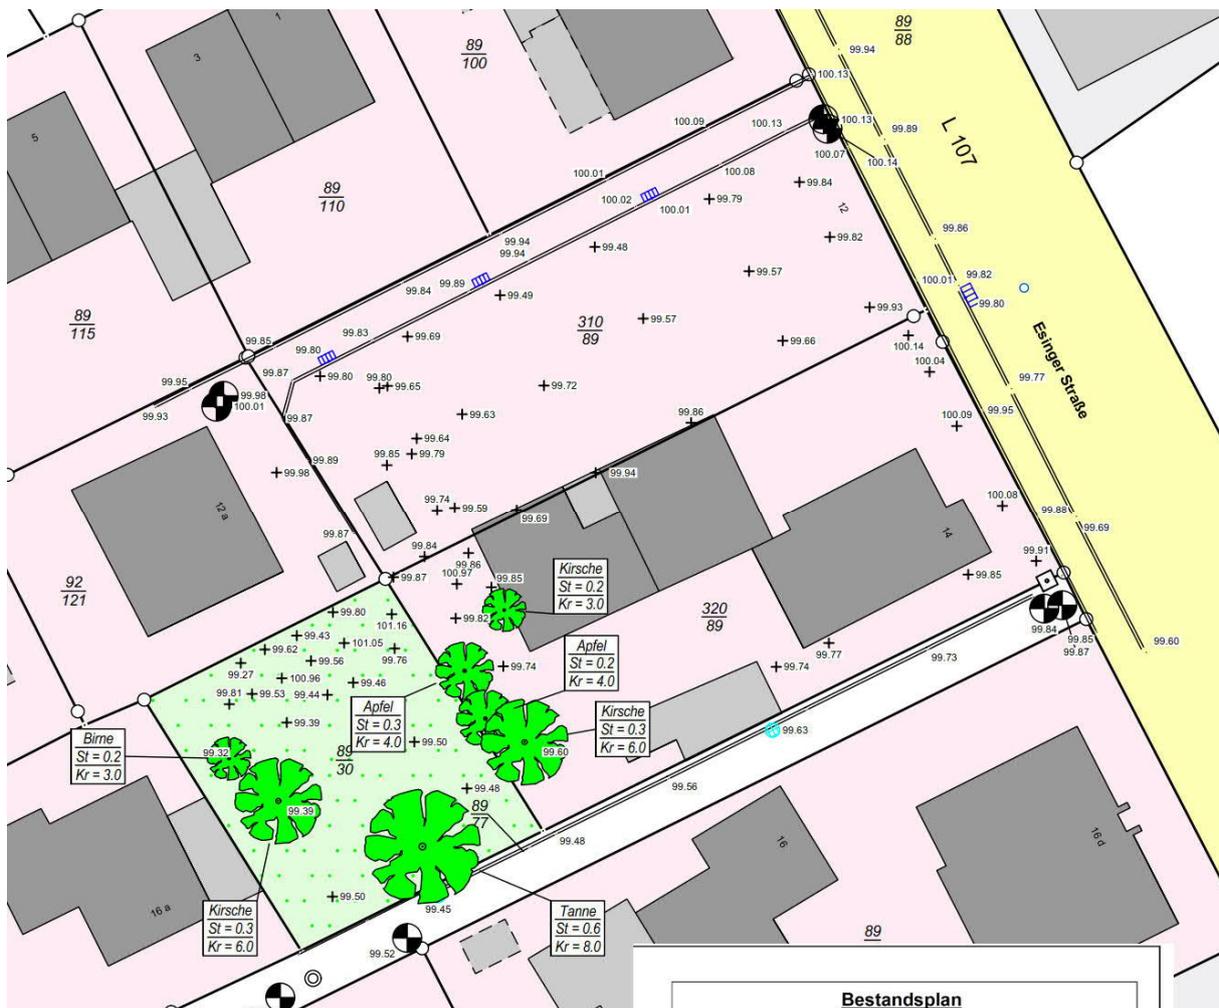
Auszug Bestandsplan Vermessung [2]
